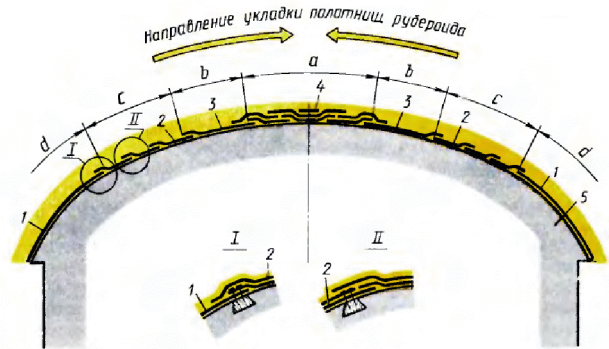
Устройство рулонной кровли на сводчатом основании:
